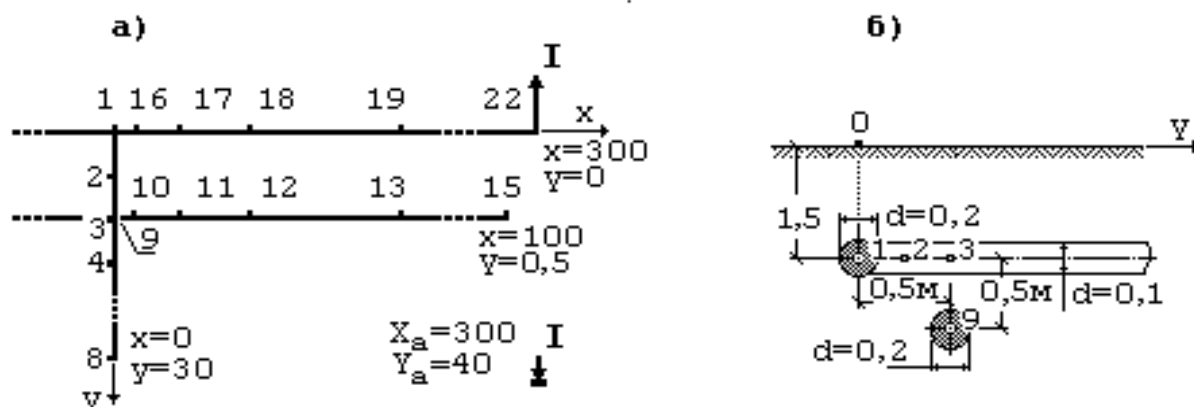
Расчетная схема участка сети с близко расположенными и пересекающимися трубопроводами.
